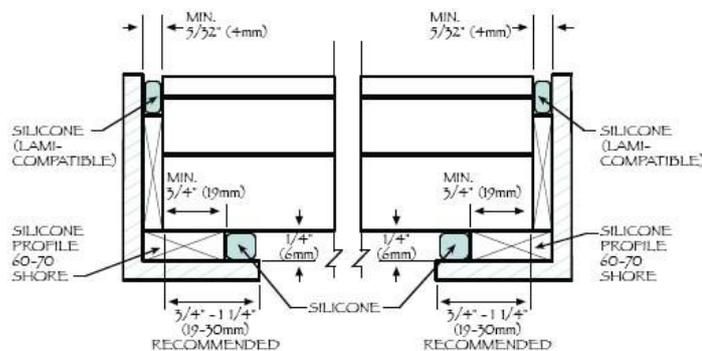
Tampak depan stuktur lantai kaca laminasi
